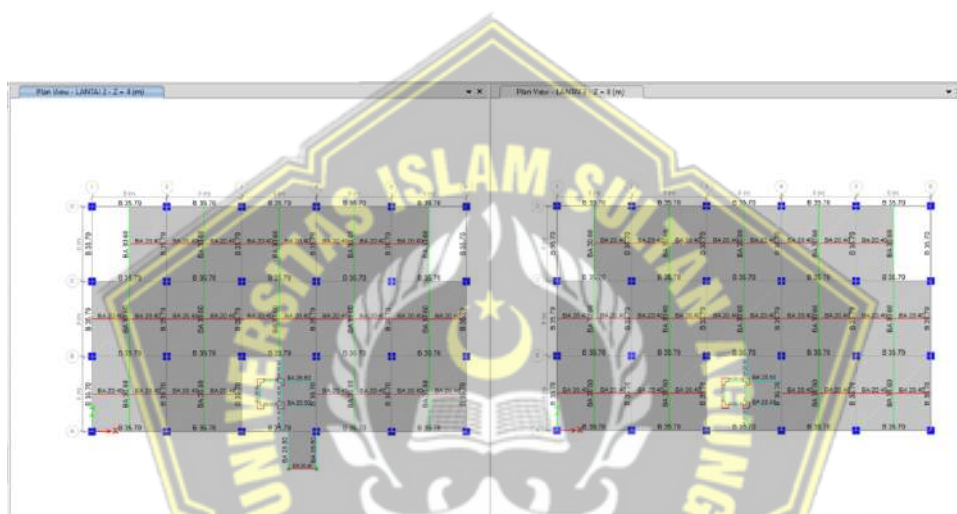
Denah Kolom Lantai 4 dan Lantai 5
